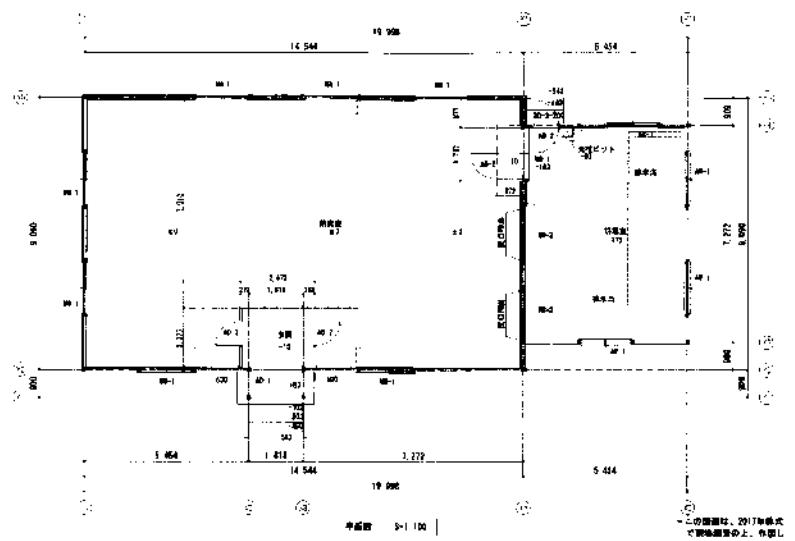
給食場 平面図 (株式会社シン技術コンサル提供)
